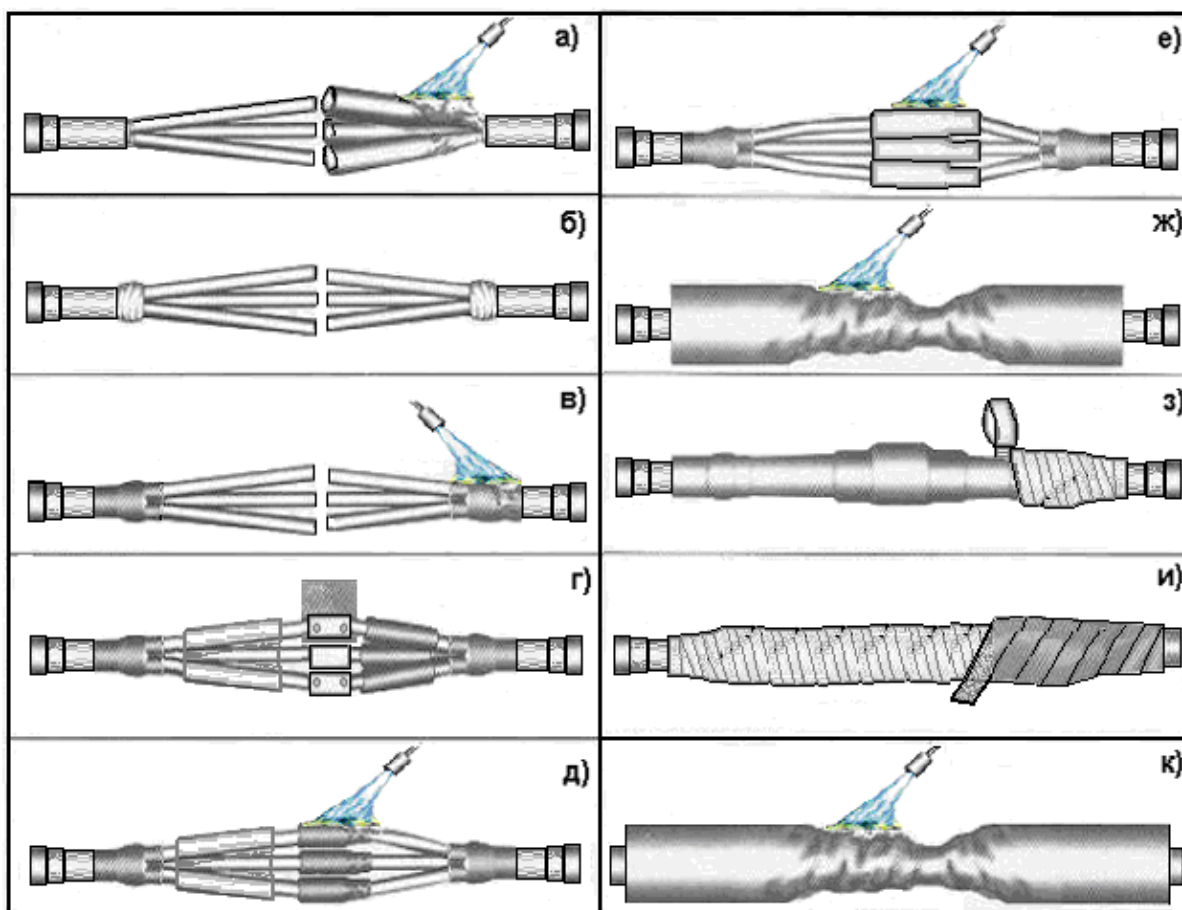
Монтаж термоусаживаемой соединительной муфты: а – усадка жильных трубок; б – намотка ленты-регулятора; в – усадка перчаток; г – соединение жил болтовыми соединителями с оборачиванием их пластинами регуляторами; д – усадка подкладных манжет; е – усадка изолирующих манжет; ж – усадка шланга; з – закрепление проводника заземления и обмотка экранной лентой; и – намотка ленты-герметика; к – усадка защитного кожуха
